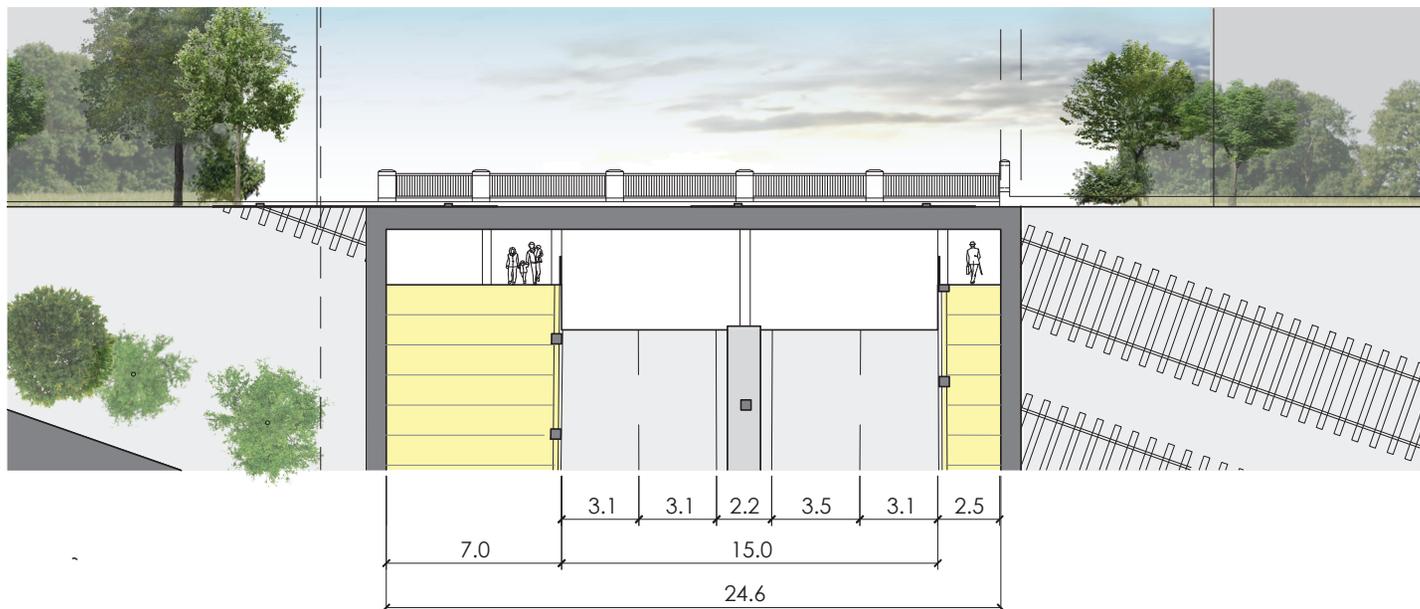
Coupe C2-C2', proposition - Av. du Parc, entre avenue Van Horne et rue Beaubien O, échelle 1:300
